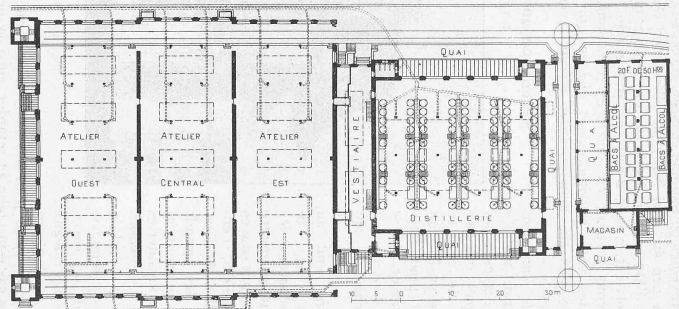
Plan du rez-de-chaussée. — Echelle 1 : 1000.
